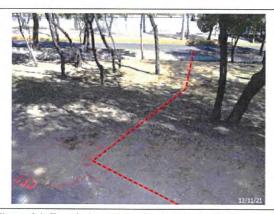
En rojo la proyección de los ejes de la calzada, ubicada en el camellón de Boulevard Adolfo López Mateos y Chivatito.
